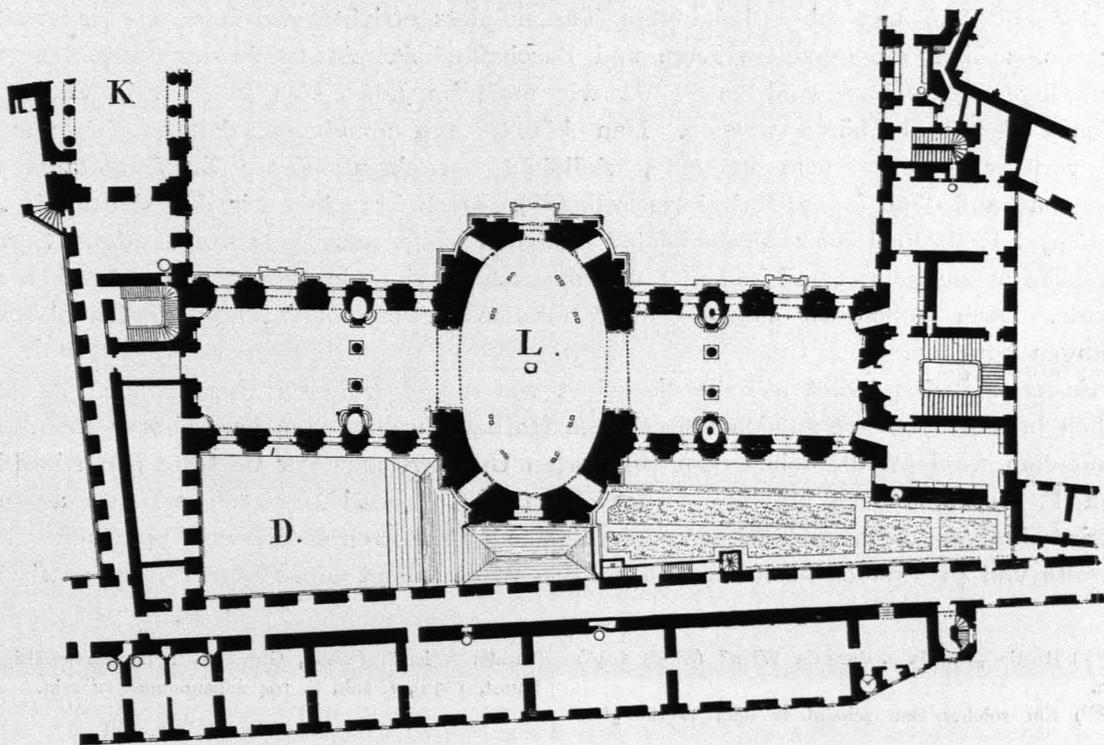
Ausschnitt aus dem „Grundriß der Kaiserburg in Wien“
